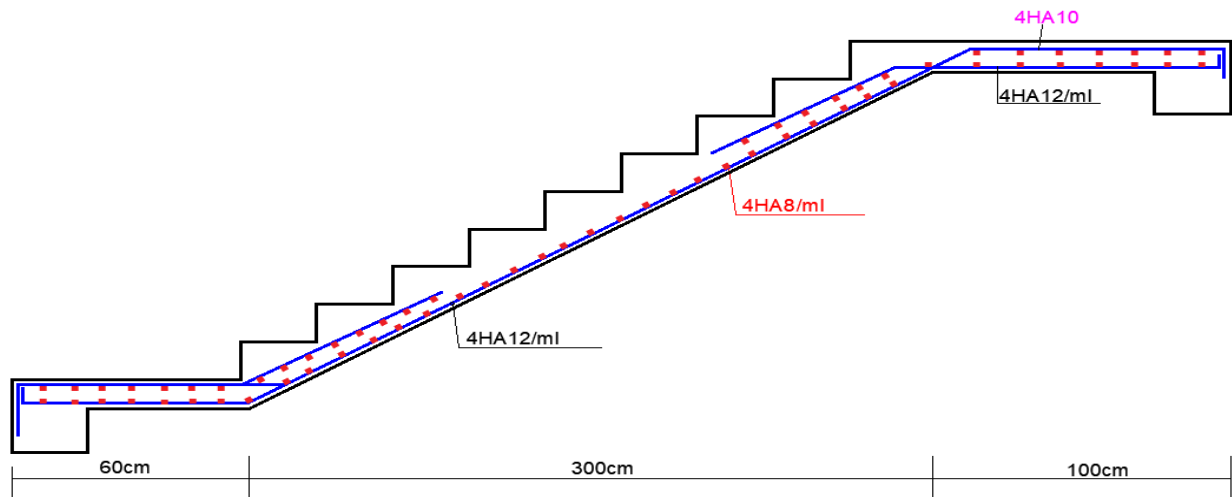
Schéma de ferrailage de l'escalier selon le CBA 93.
